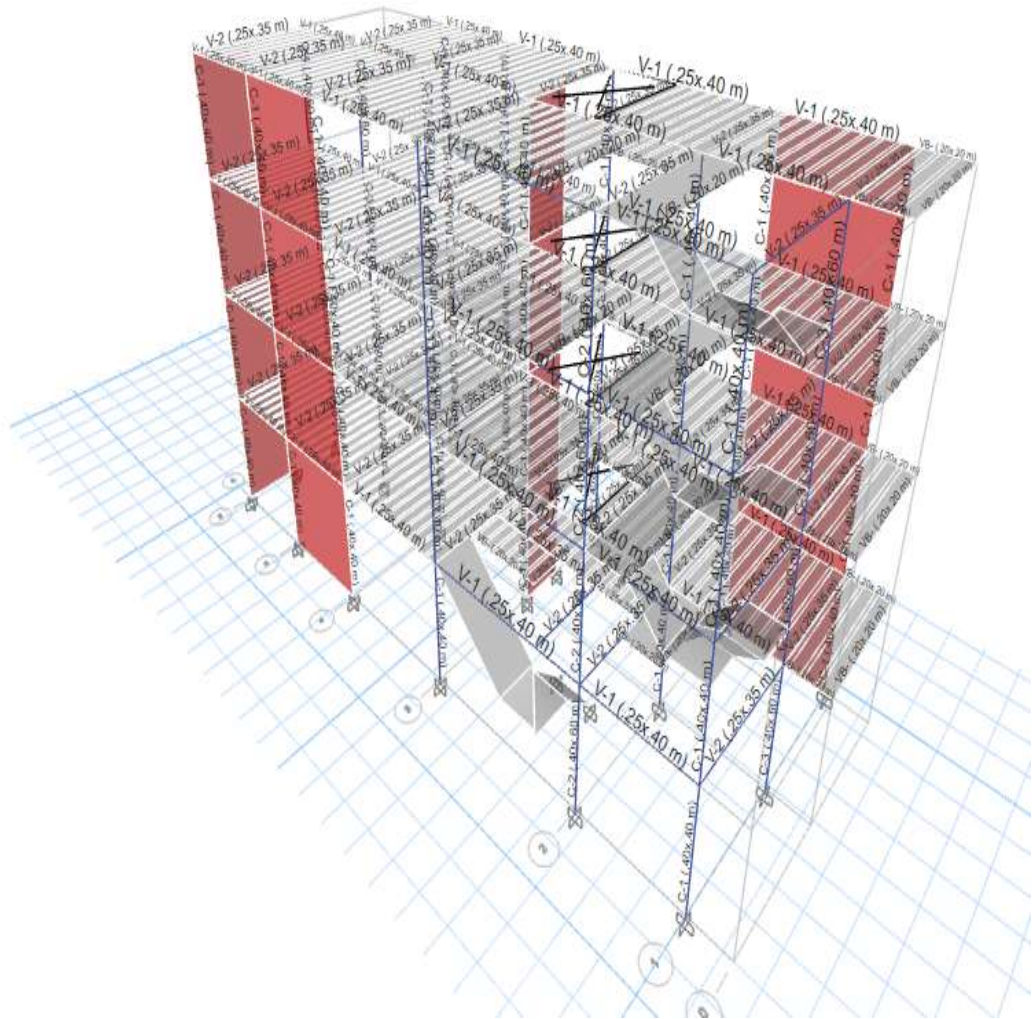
Vista 3d con las Secciones de la Edificación
